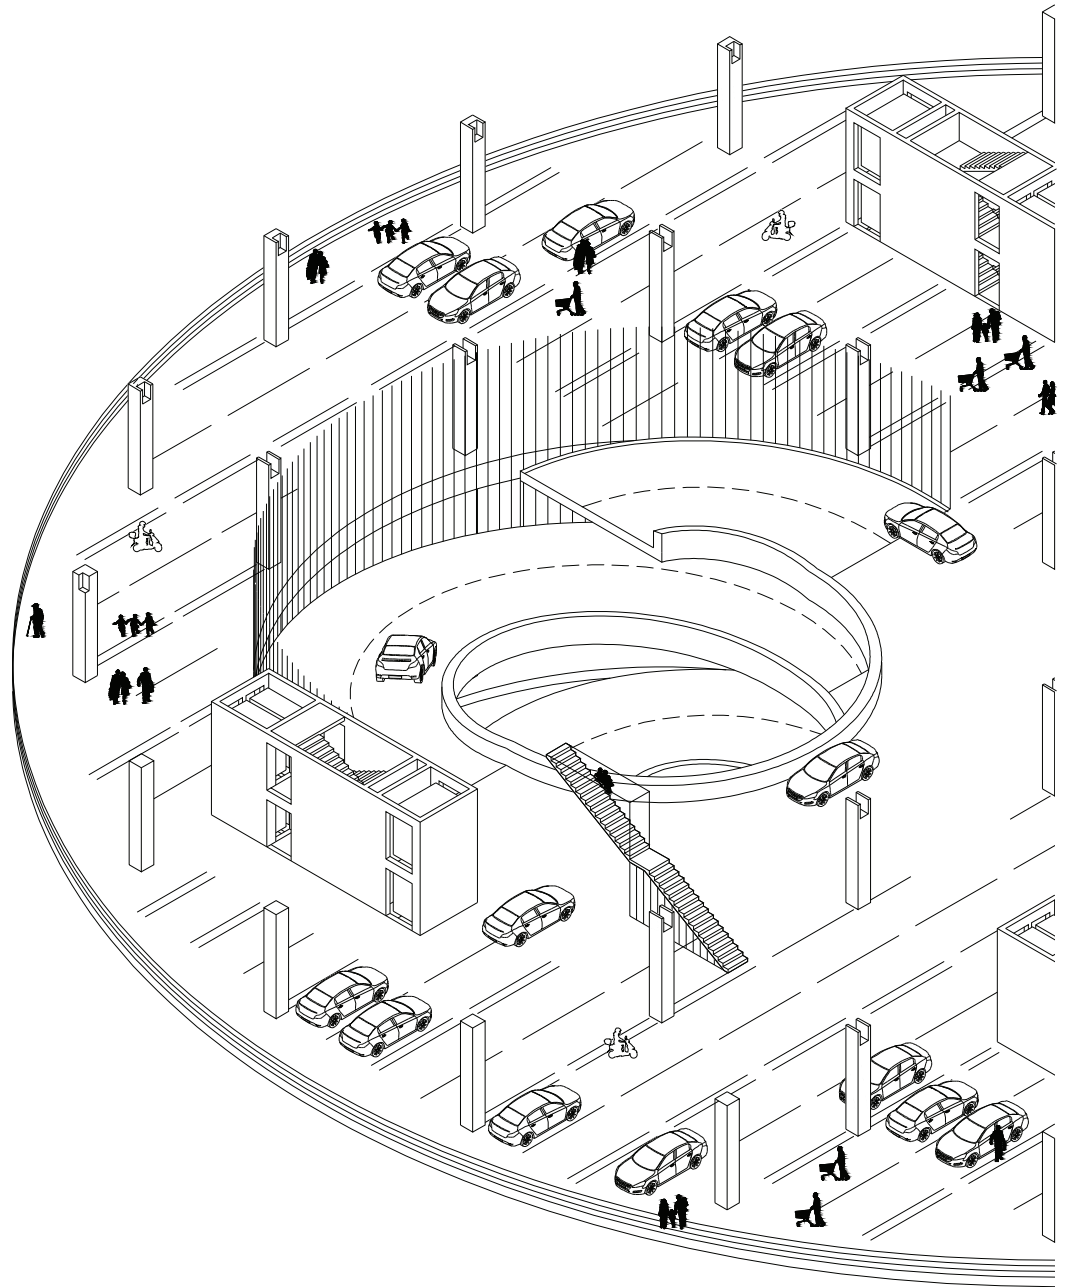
Grundrissaxonometrie . Erdgeschosszone . 1:400
